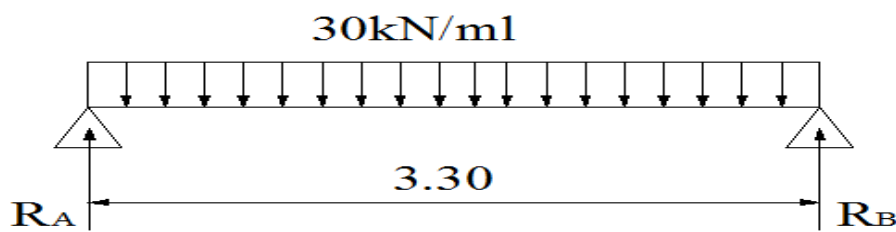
Schéma statique de la poutre palière a l'E.L.S.
